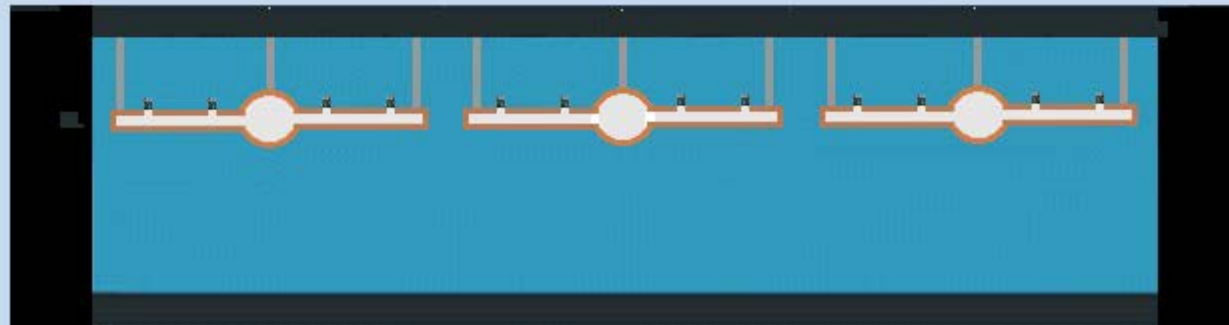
Распределительные  и питающие  трубопроводы, жёстко подвешенные под потолком подвала. -спринклер. -подвеска. Упругая конструкция из нижней и верхней плит подвала в положении устойчивого равновесия в отсутствии резонансных колебаний.
